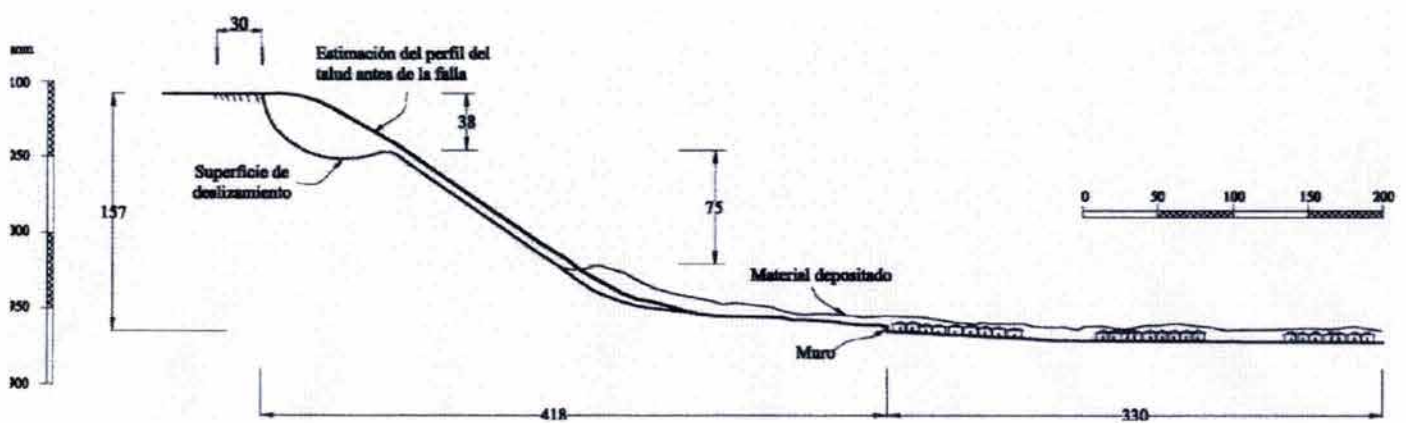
, Esquema de la planta del deslizamiento en la ladera “Las Colinas”
